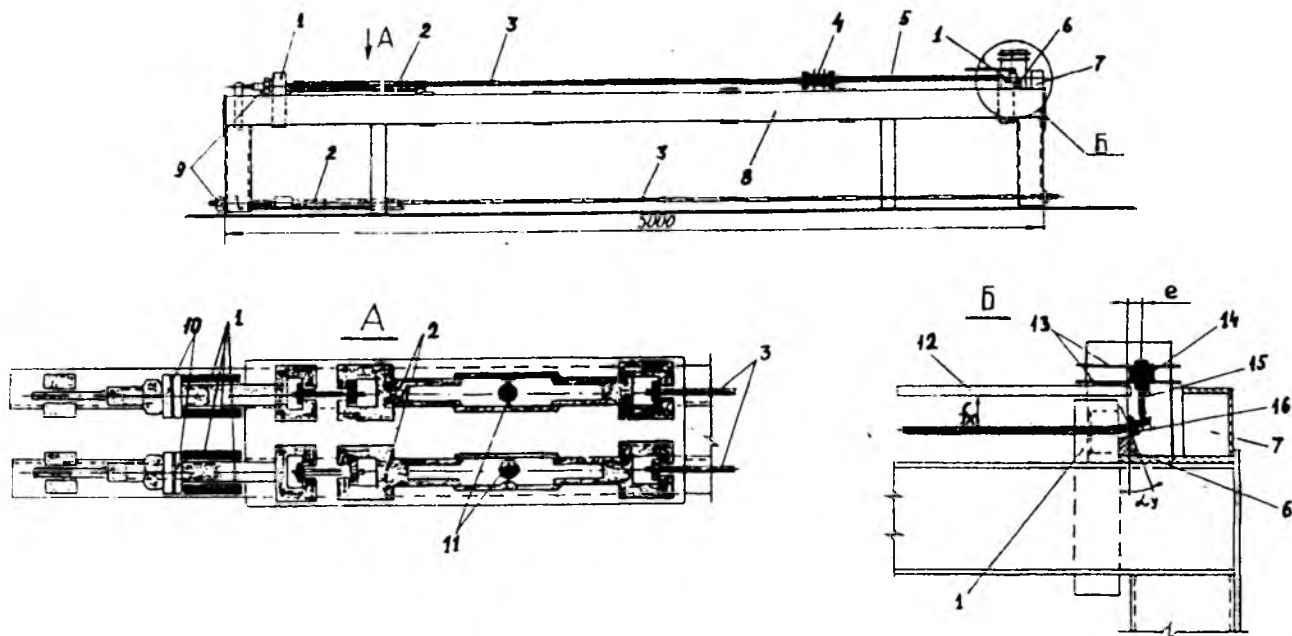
Стенд для исследования натяжения арматуры на упоры с наклонной опорной поверхностью
